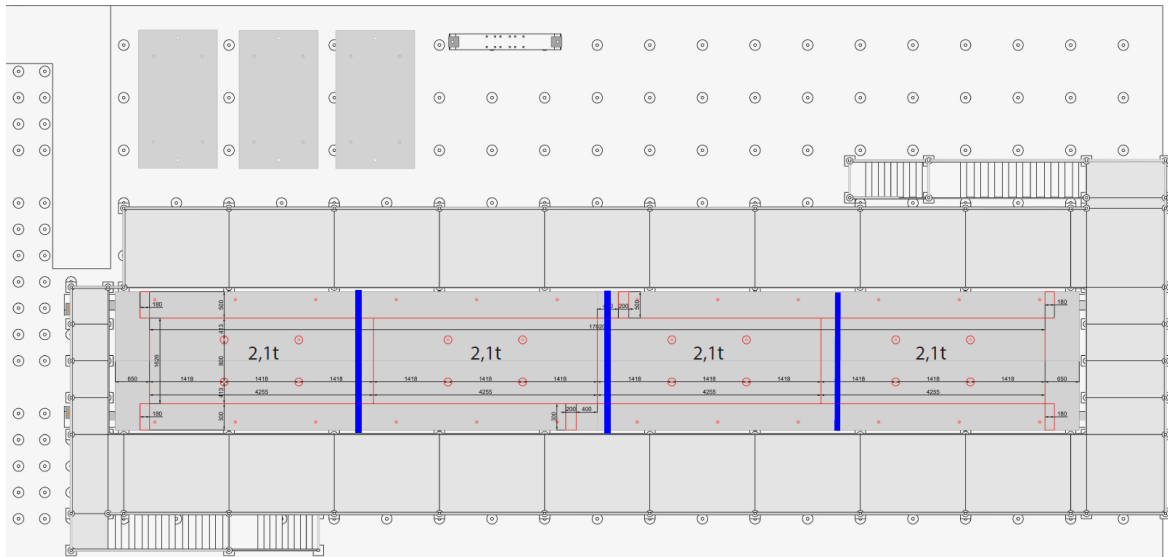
Localisation des fissures sur la plan de démolition (en bleu)
